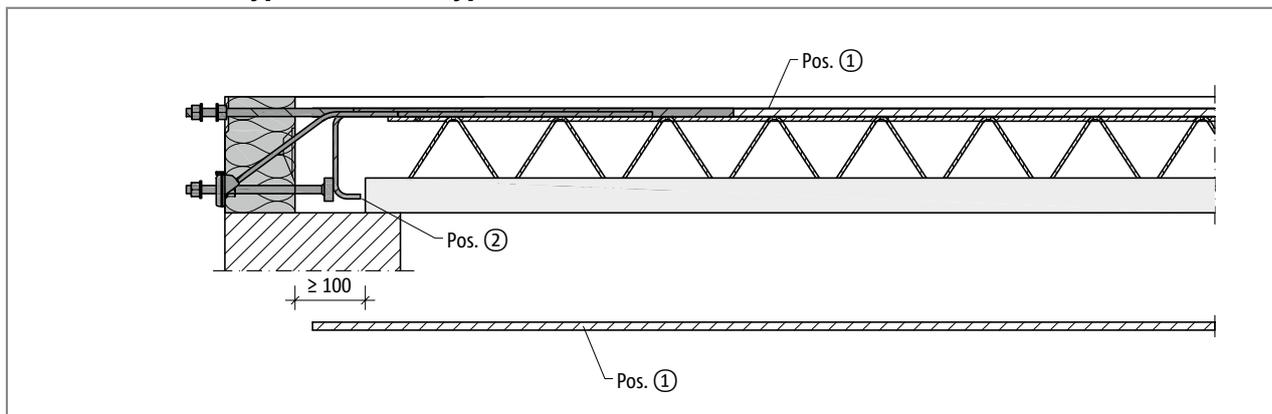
Schöck Isokorb® XT Typ SK-M1: Bauseitige Bewehrung bei Halffertigteilbauweise, Schnitt
